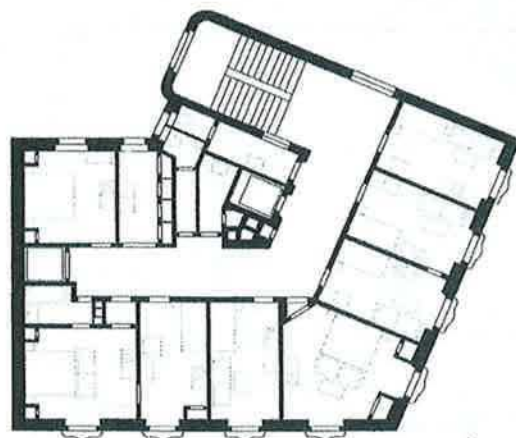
Ejemplo de plano de planta de mobiliario.
